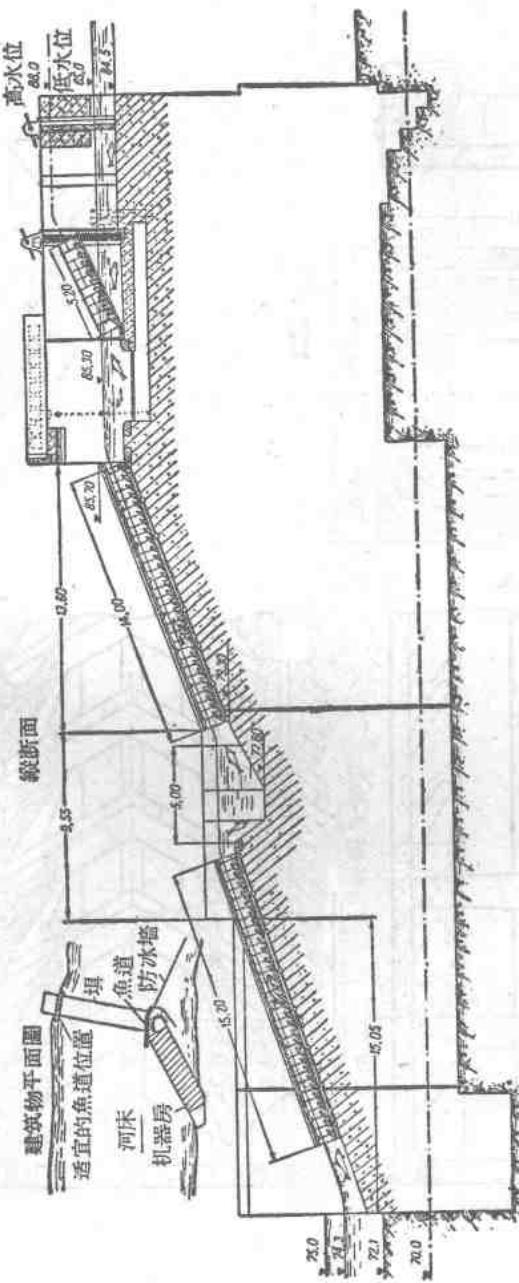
中水头的水电站鱼道。建筑物的平面和纵断面图
